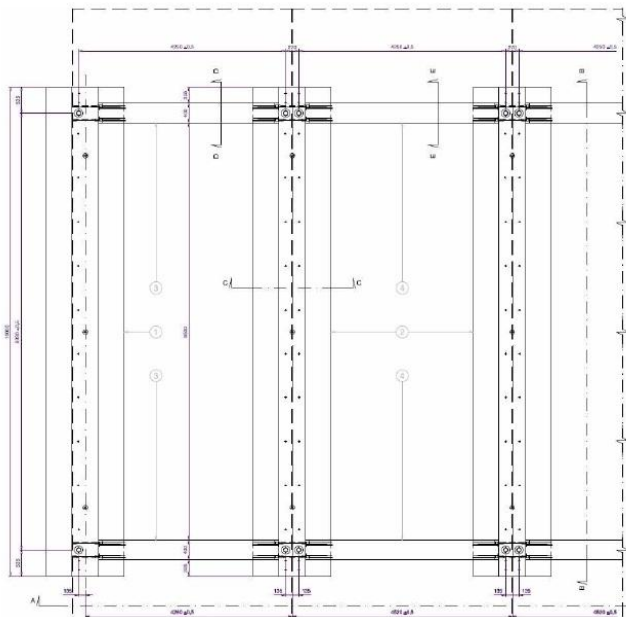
Vista general de una cimentación resuelta con la cimentación prefabricada del sistema Compact Habit®
